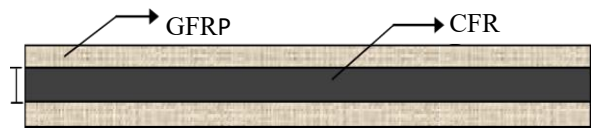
Detail Pemasangan Lapisan CFRP pada Balok.
